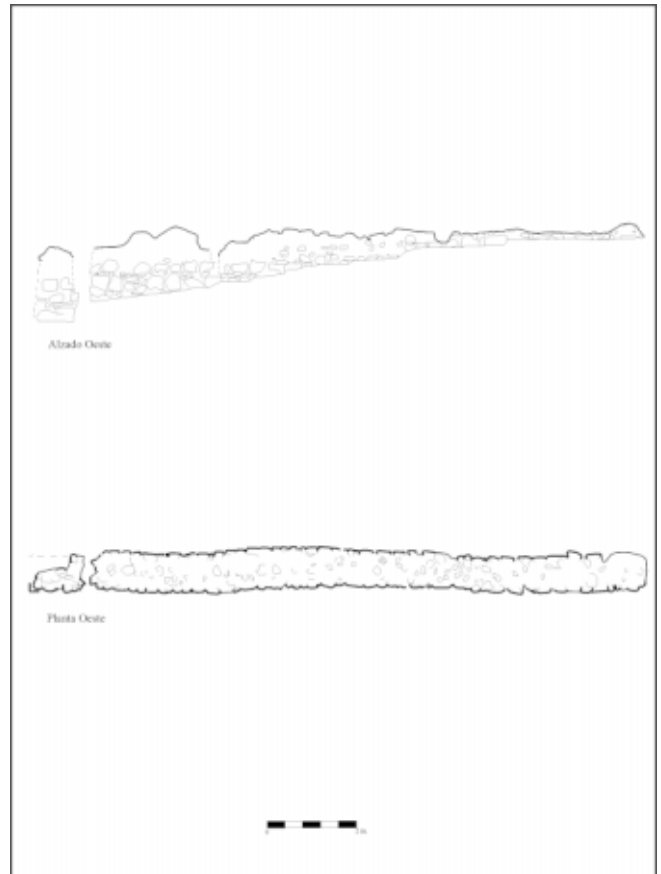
Castellum Aquae. Planta y Alzado. Muro Oeste.
